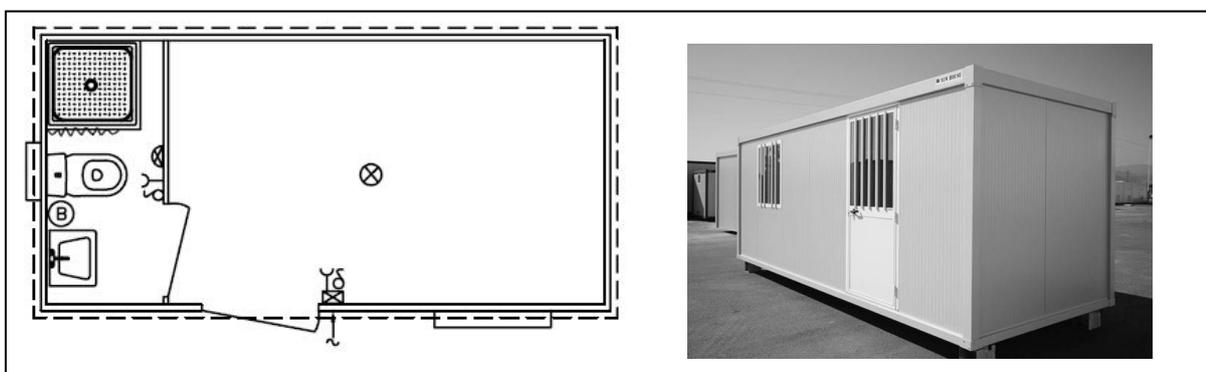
pianta e foto di una baracca da cantiere. Immagini tratte da www.newhouse.it
